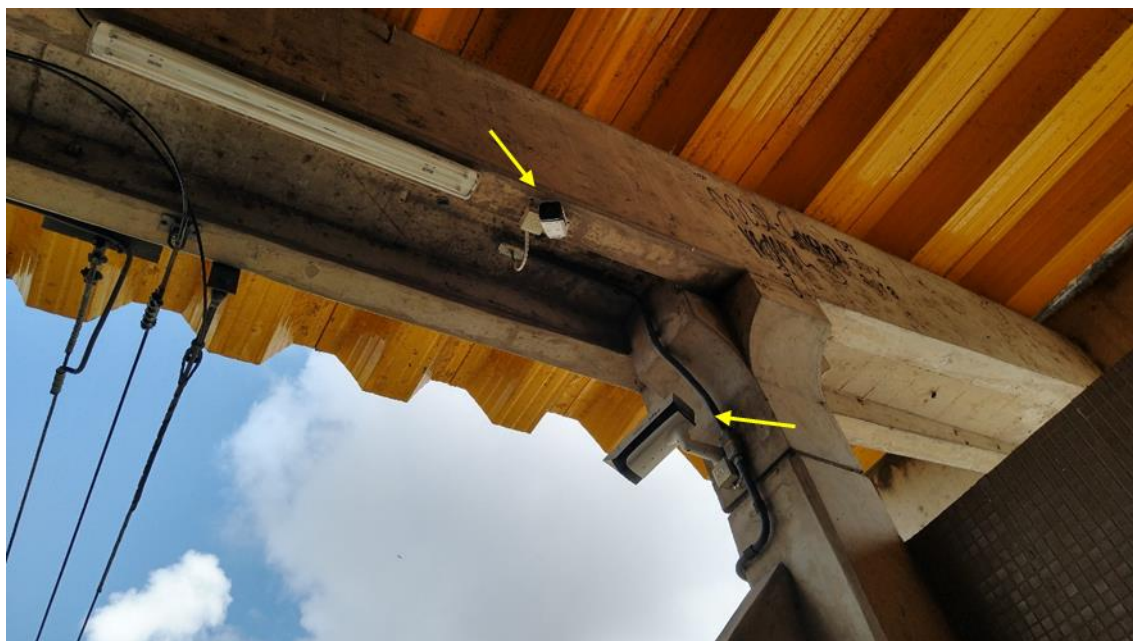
Câmera em viga da plataforma: Estação Joana Bezerra
